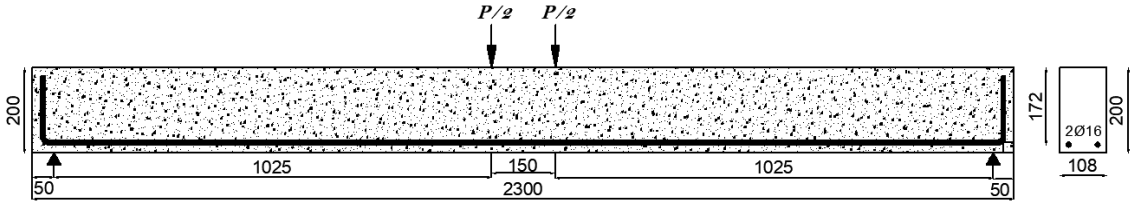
Minimum donatı oranında donatılı numunesinin geometrik özellikleri ve donatı çizimi
